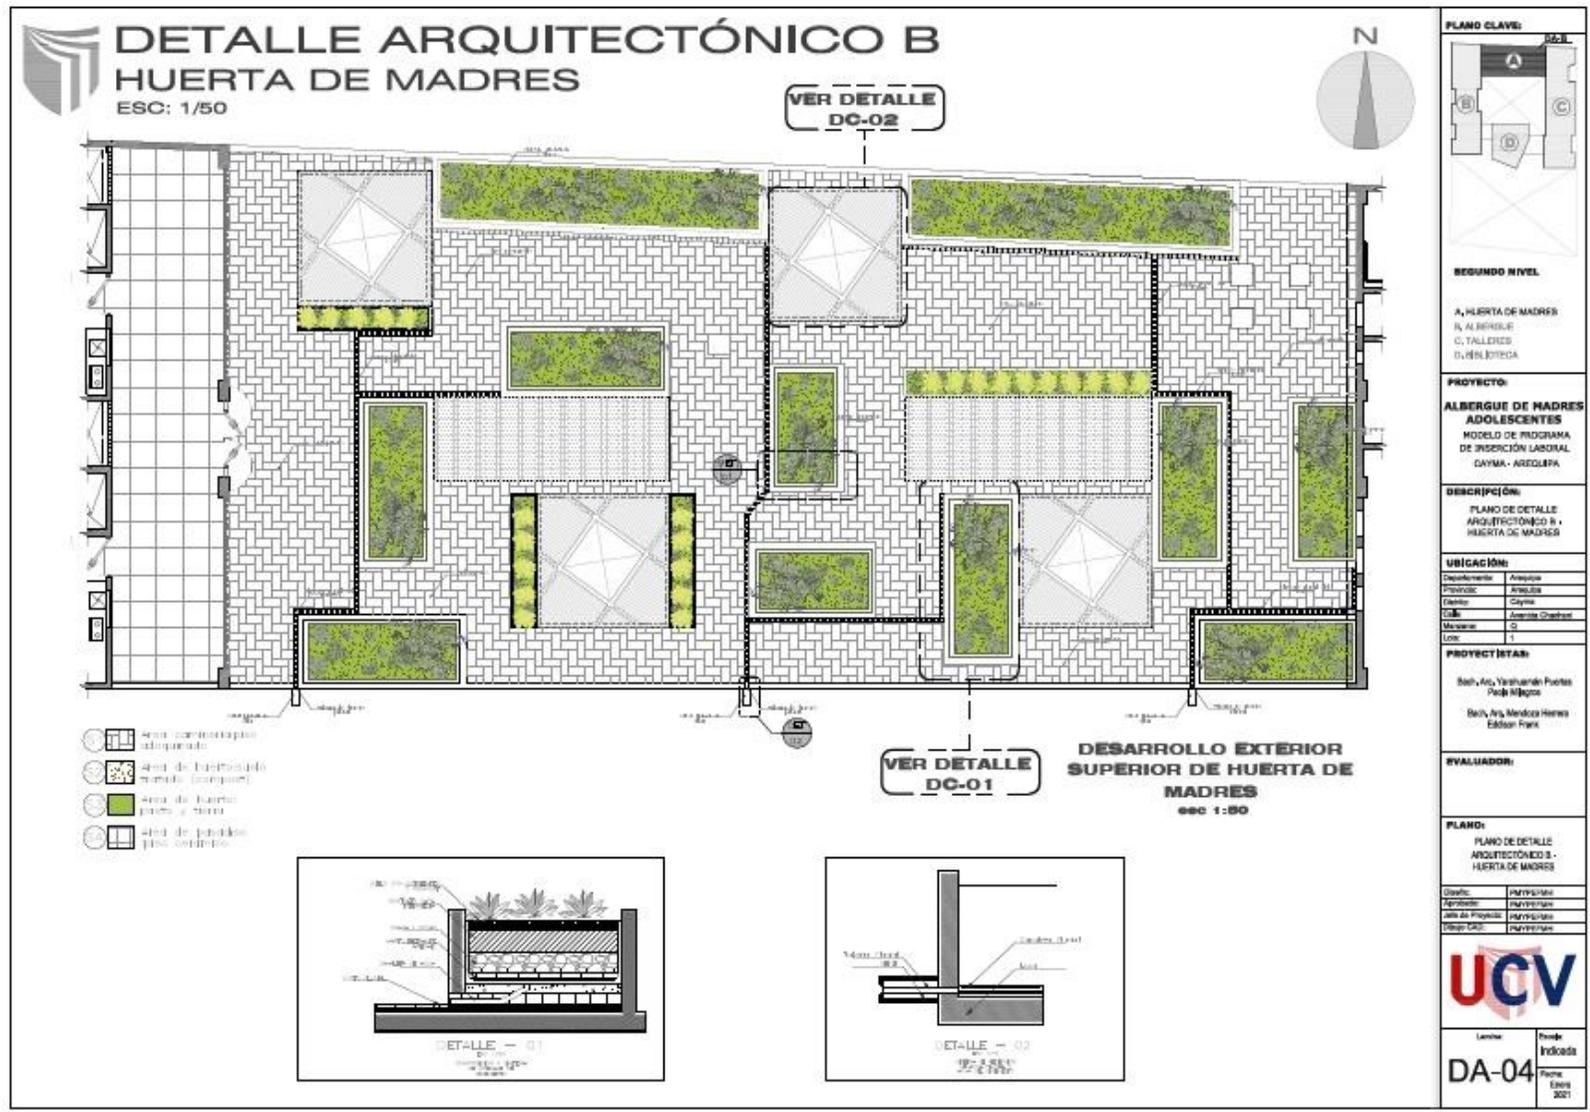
Detalle Arquitectónico B – Huerta de Madres de Albergue DA-04.
